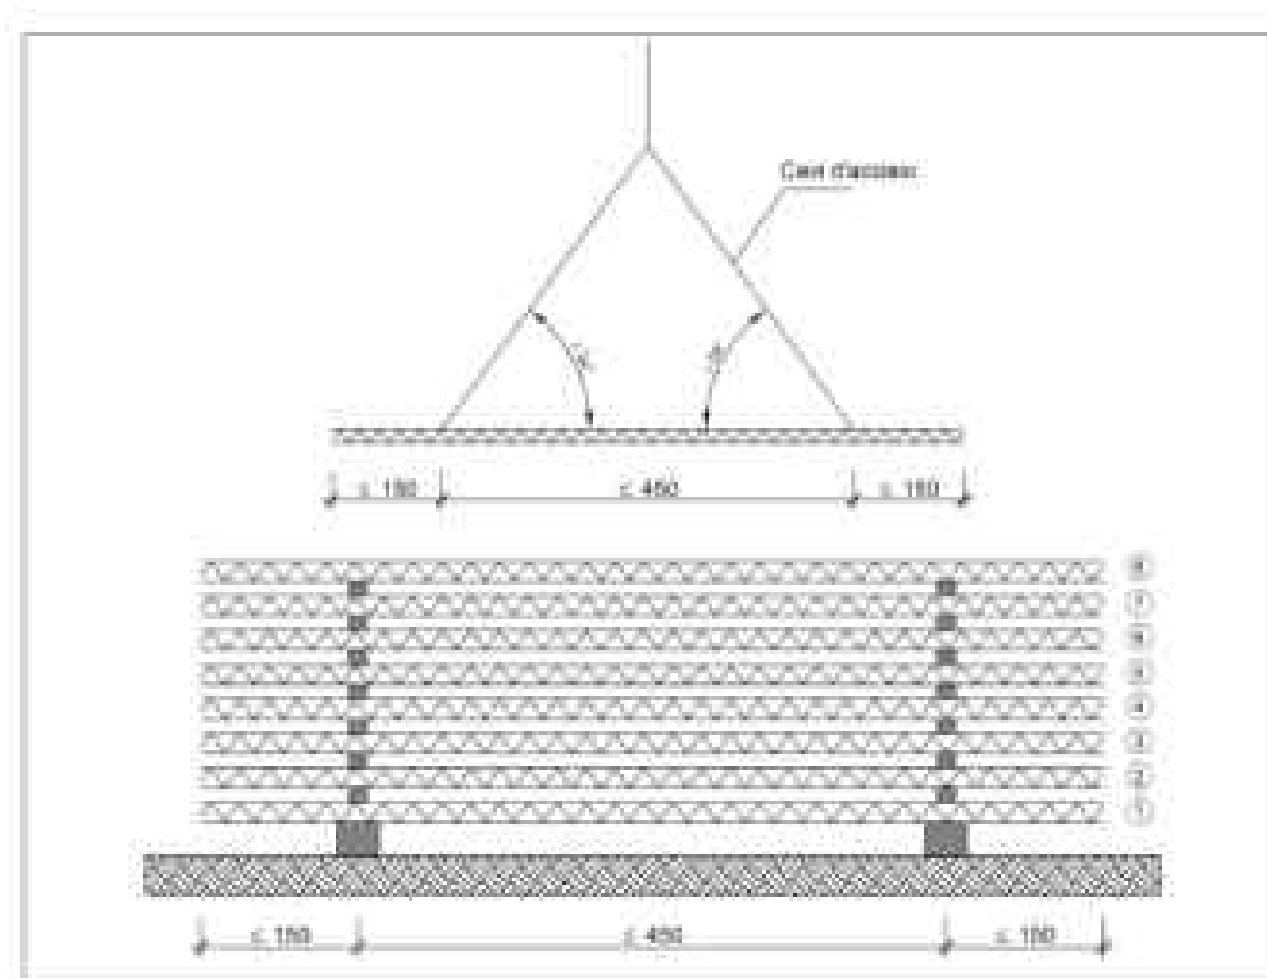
Esempio di stoccaggio di travetti tralicciati
